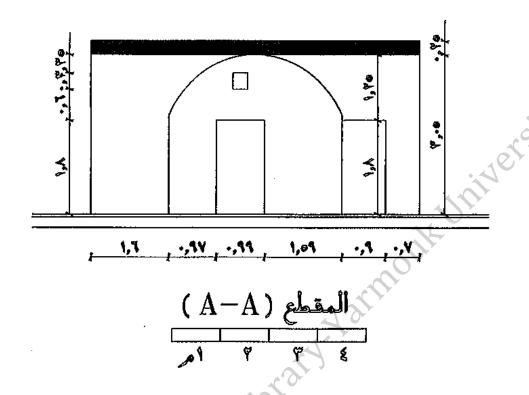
مسقط عمودي تخيلي لمقام محمد العنقي في الصريح (بمساعدة المهندس سمير الاعتر،٢٠٠٨)
